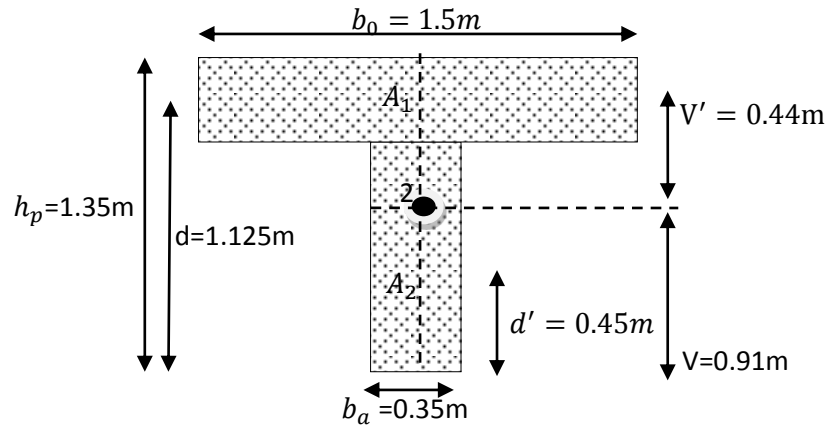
Les dimensions de la section de la poutre de rive avec hourdis
